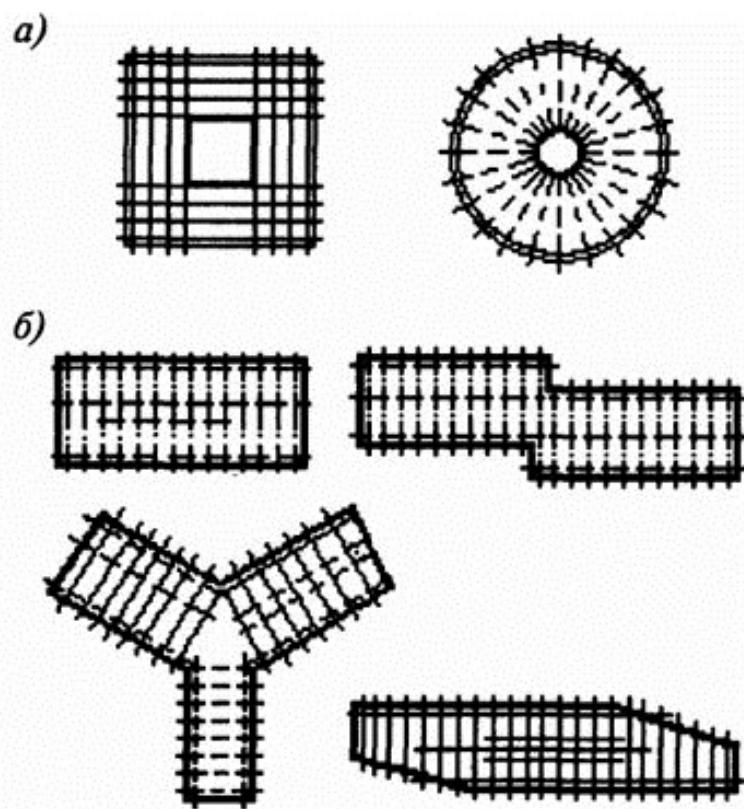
Формы планов многоэтажных зданий: *а* - здания с компактными планами; *б* - здания с протяженными планами
